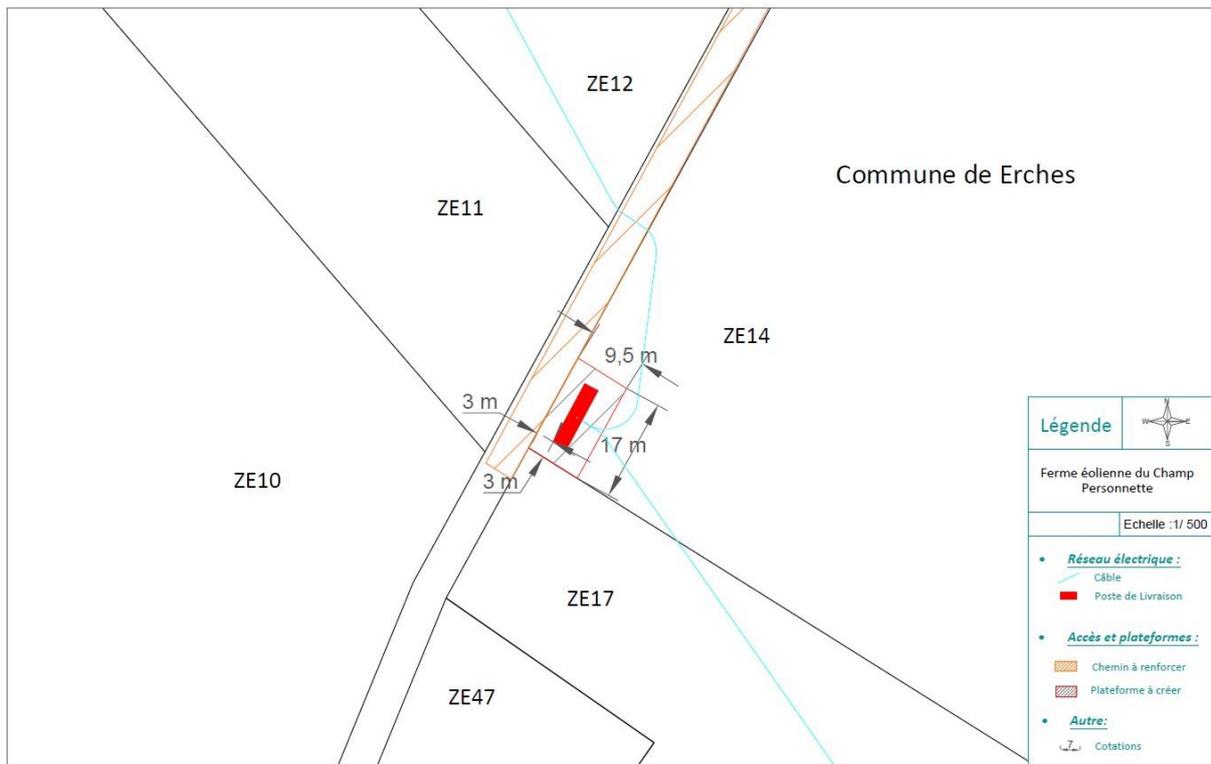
Plan du poste de livraison 11 m x 2,5 m
